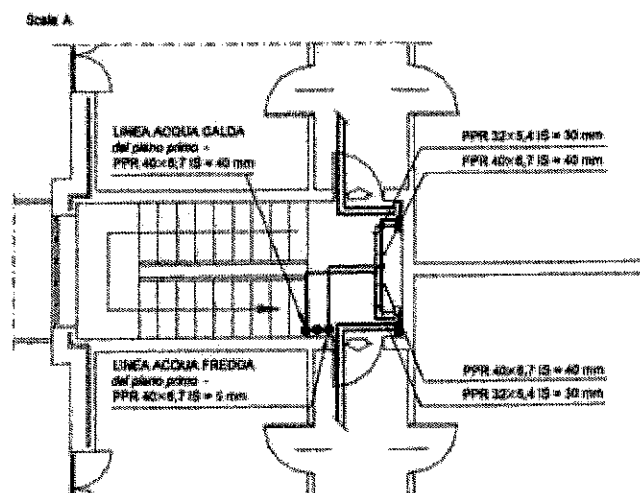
Pianta piano secondo con impianti (scala A).
